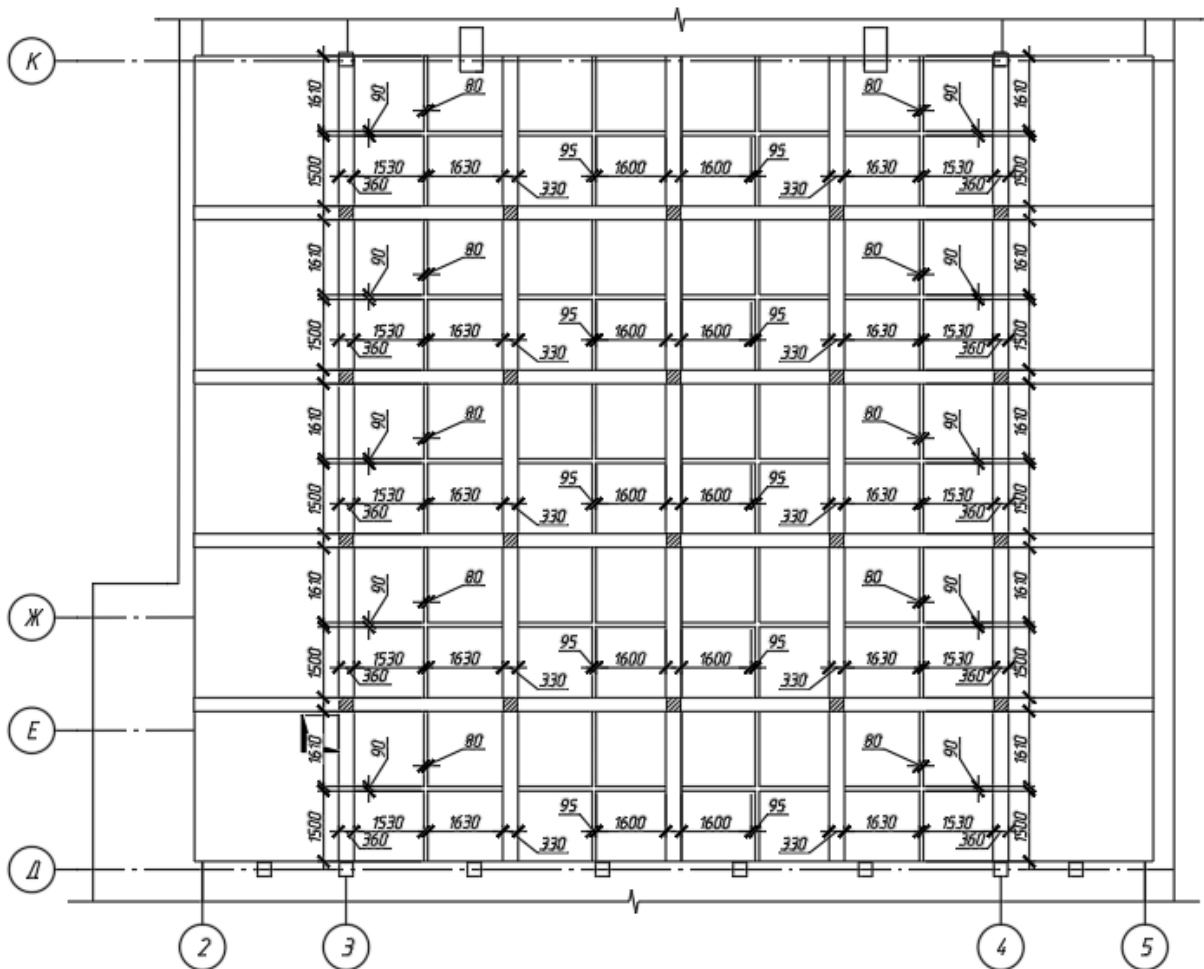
Схема залізобетонної монолітно-ребристої плити перекриття в осях 2-5/Д-К
